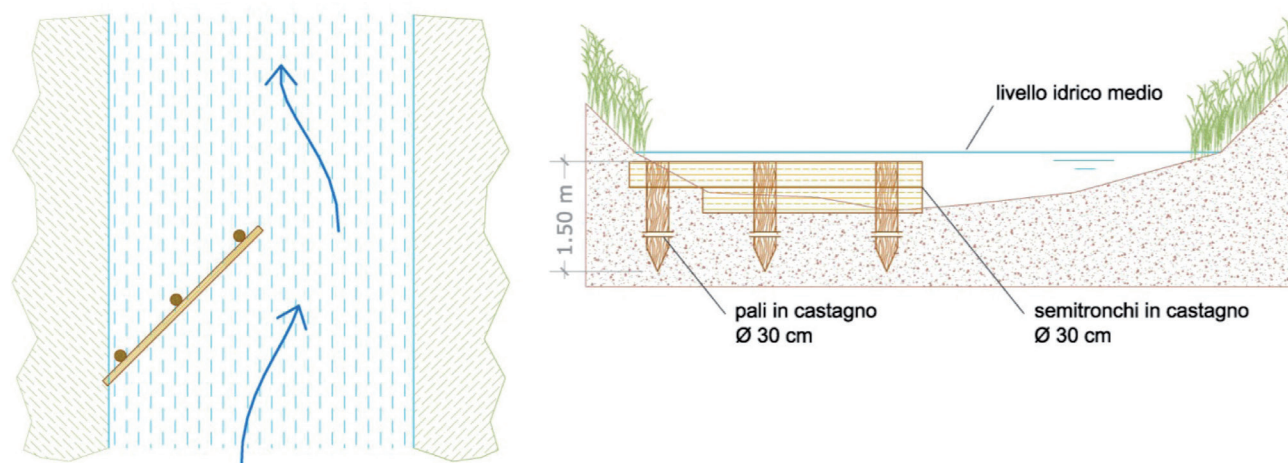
DEFLETTORE SINGOLO - INTERVENTO TIPO. PLANIMETRIA E SEZIONI
